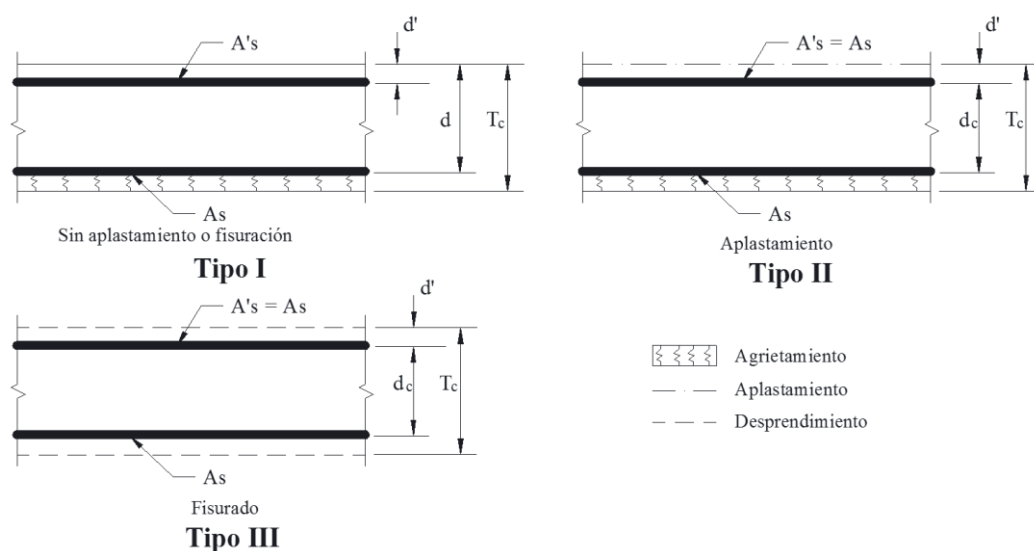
Típicos refuerzos en secciones de concreto, UFC 2008.
